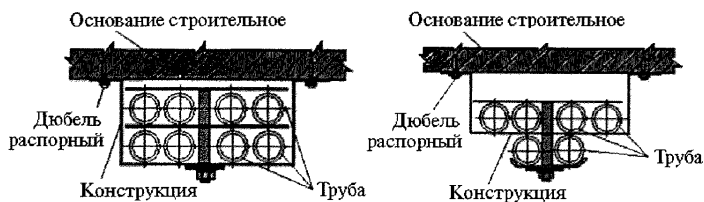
Крепление пластмассовых труб с применением электромонтажной конструкции к строительному основанию с помощью распорного дюбеля
